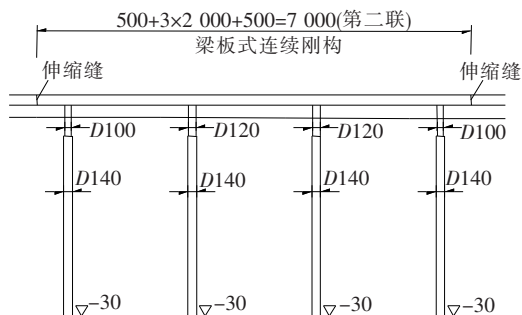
桥梁立面图(除标高单位为 m 外,其余:cm)
